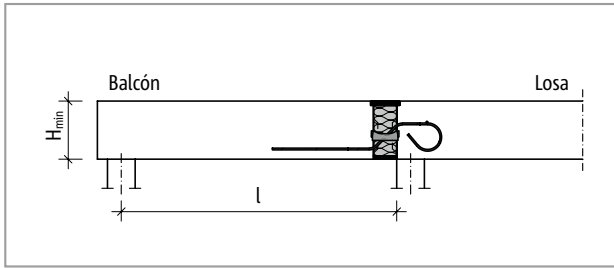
Schöck Isokorb® T tipo Q: Sistema estático (T tipo Q-V1 hasta Q-V5)
